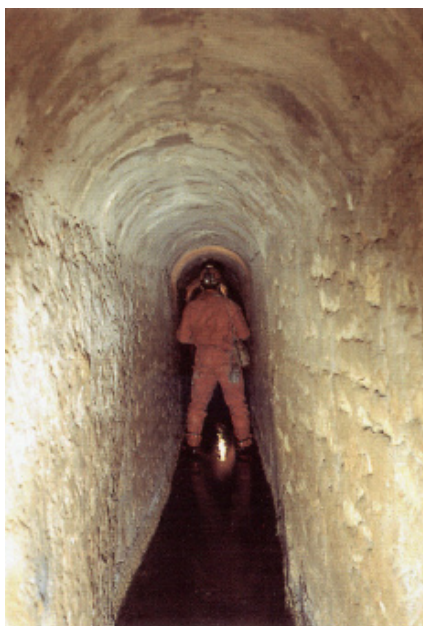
Tratto dell'acquedotto di Faicchio con pareti in muratura e volta a tutto sesto (foto S. Capasso, da Caiazza, 1997).
